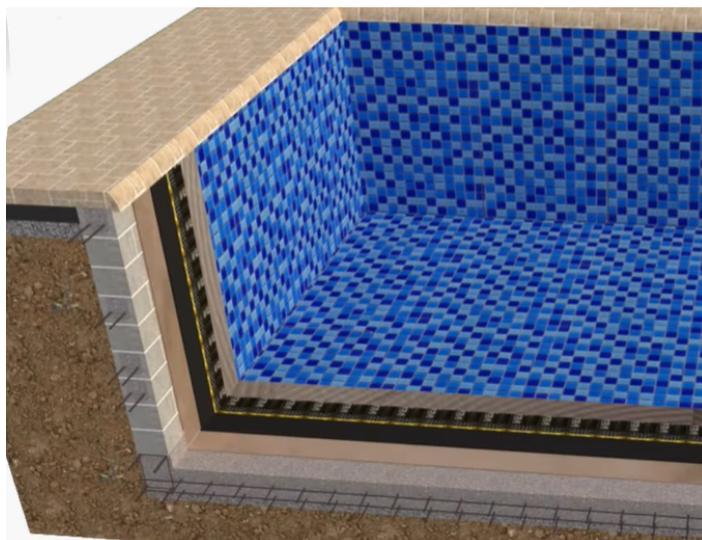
Corte esquemático de uma piscina de alvenaria na fase estrutural
